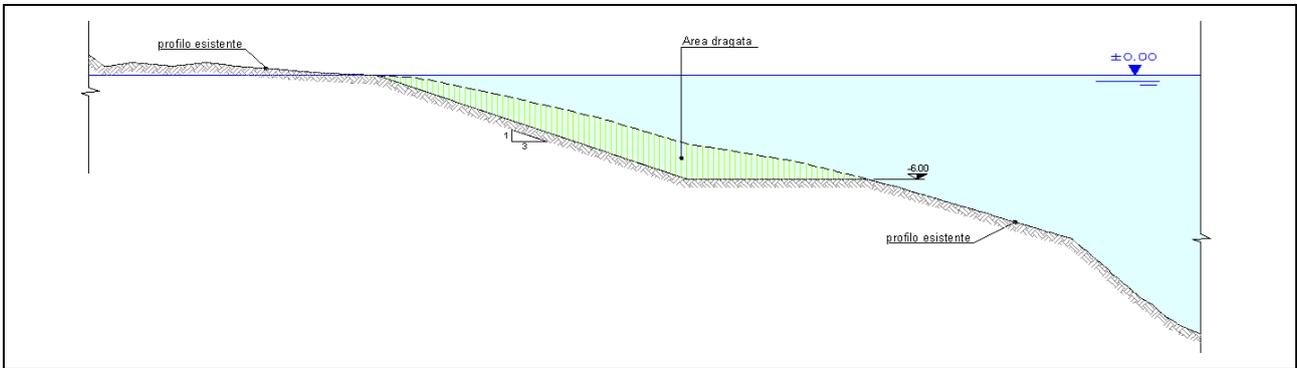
Sezione tipica del dragaggio nel tratto meridionale (sezione A-A)
